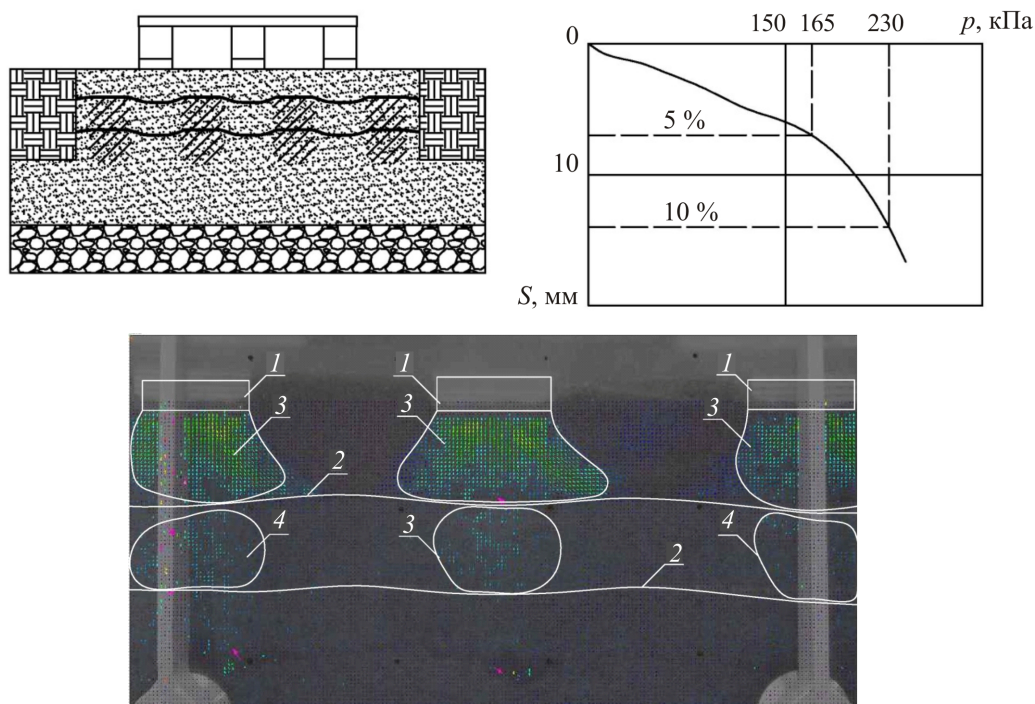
Двухслойное армирование с преднапряжением армирующих слоев за счет добавки набухающего материала: 1 – штампы; 2 – зоны средних перемещений; 3 – зоны минимальных перемещений; 4 – расположение армирующих слоев
